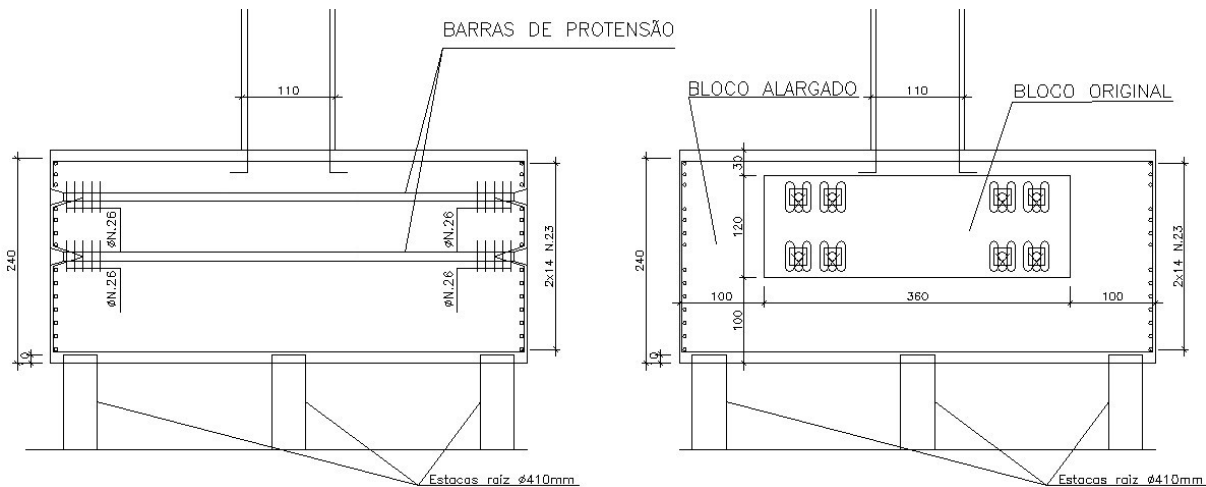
Detalhes do envolvimento do bloco original pelo novo bloco, e das armaduras de protensão.
